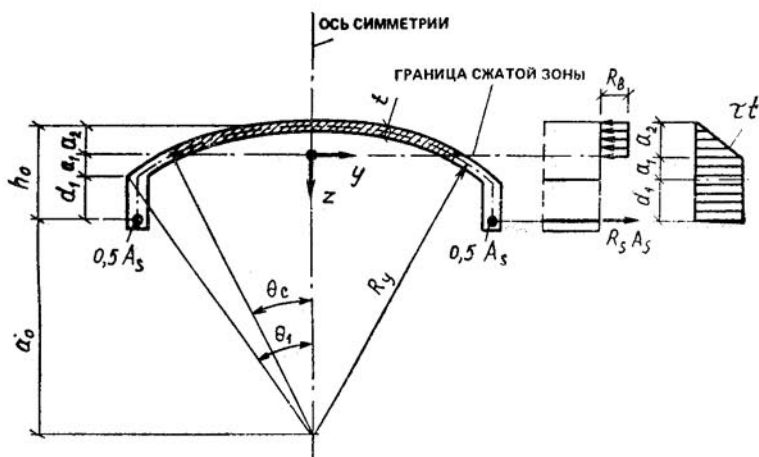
К расчету длинной цилиндрической оболочки по предельному состоянию как железобетонной балки
